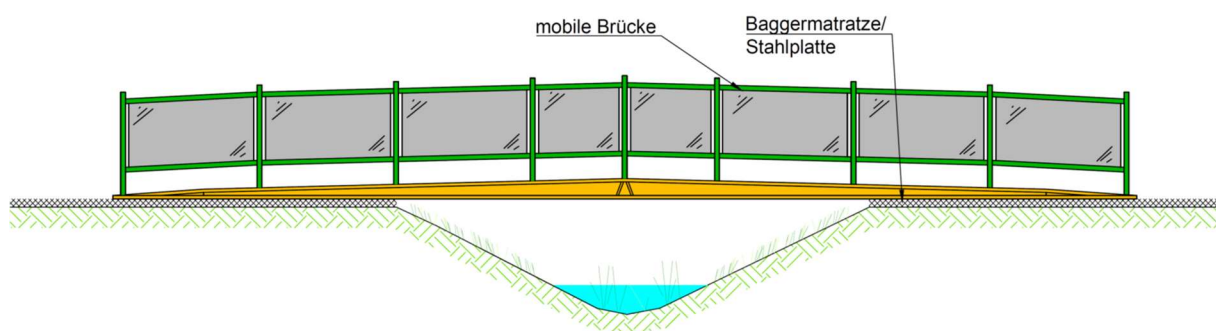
Prinzipskizze zum Einsatz mobiler Brücken
